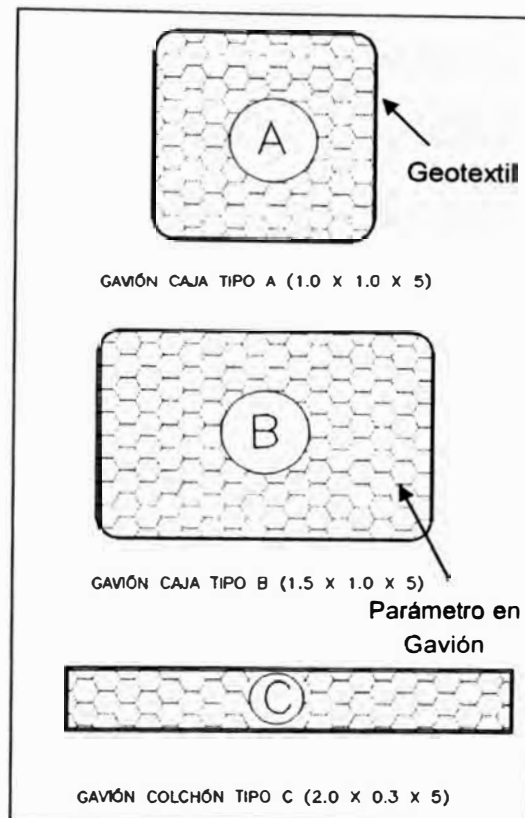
Tipo de gaviones utilizadas en el proyecto.
